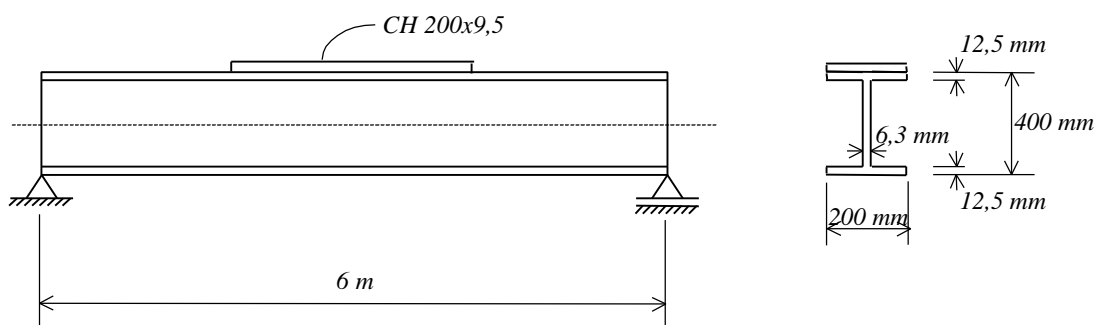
Vão da viga e seção transversal considerados na verificação de viga com lamela.
